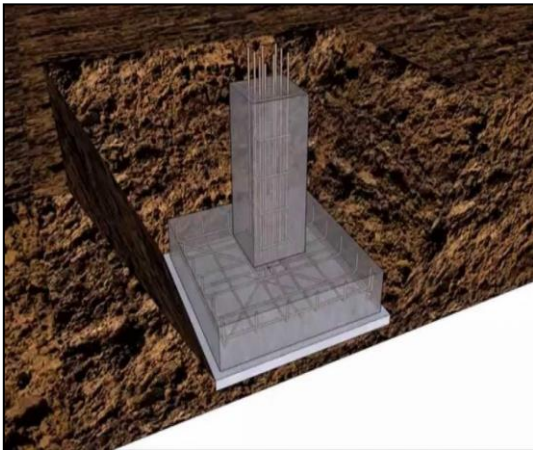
Zapata aislada y corrida, fuente: Waterhouse, sketchup.
